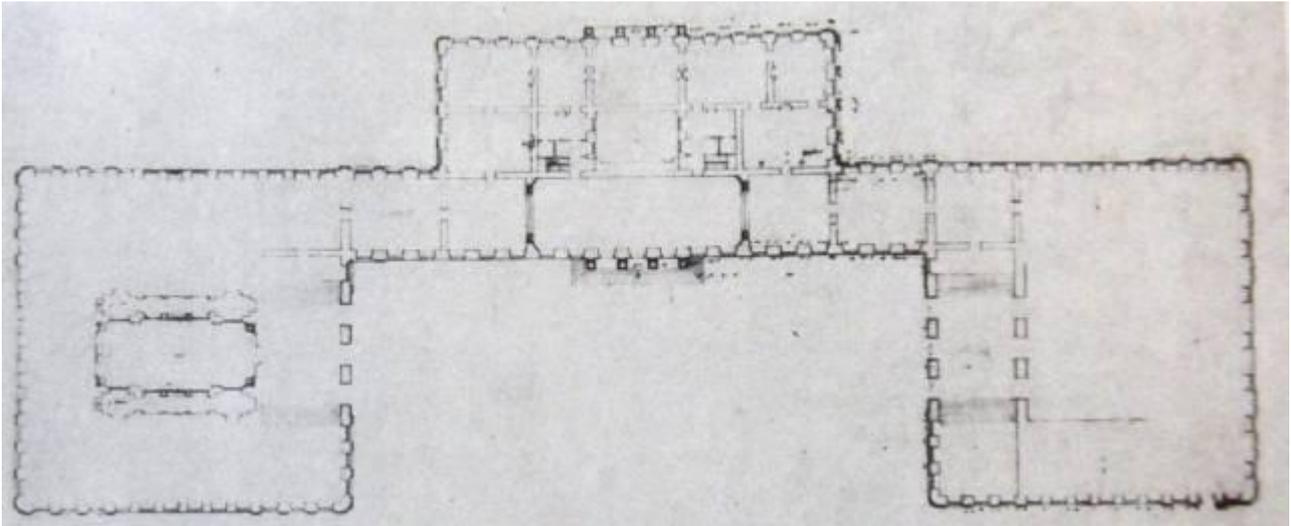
Jean Nicolas Jadot, Entwurf für den königlichen Palast in Buda, Grundriss
